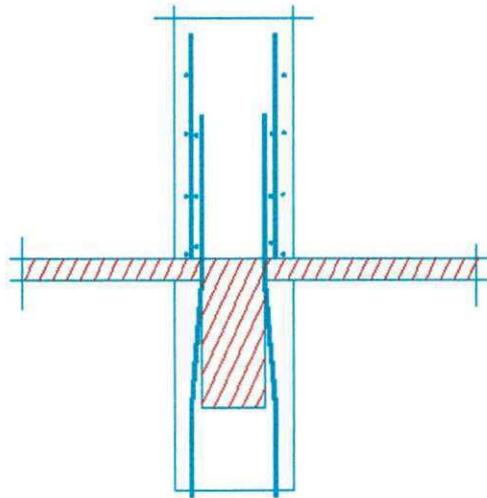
ferro de espera dos pilares dobrados para o interior da continuidade do pilar.
